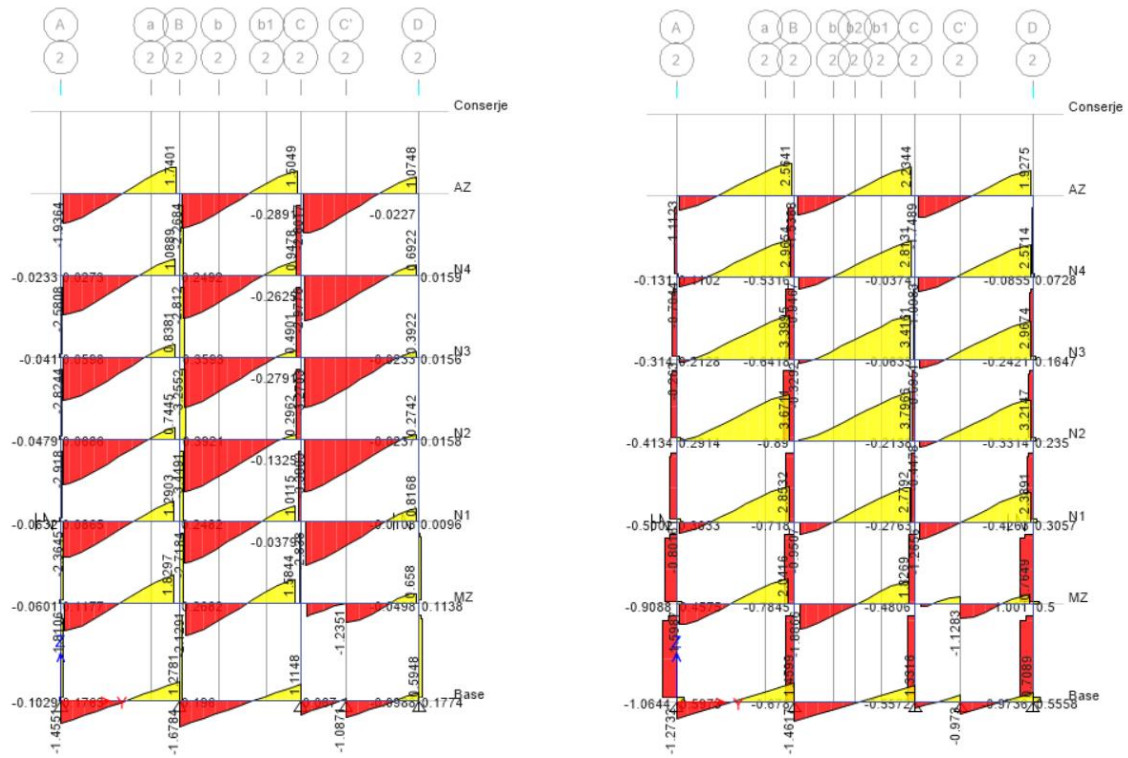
Cortes en vigas elevación 2. Modelos F y G respectivamente.
